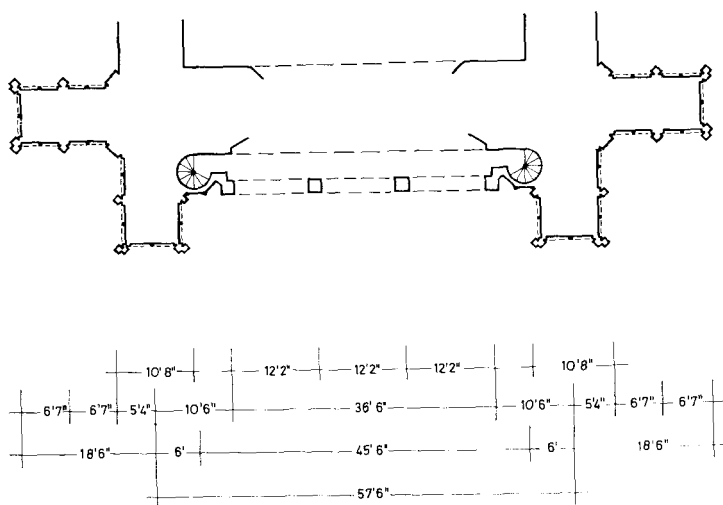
Ulm Münsterturm Riß A, schematischer Grundriß des Martinsgeschosses.
